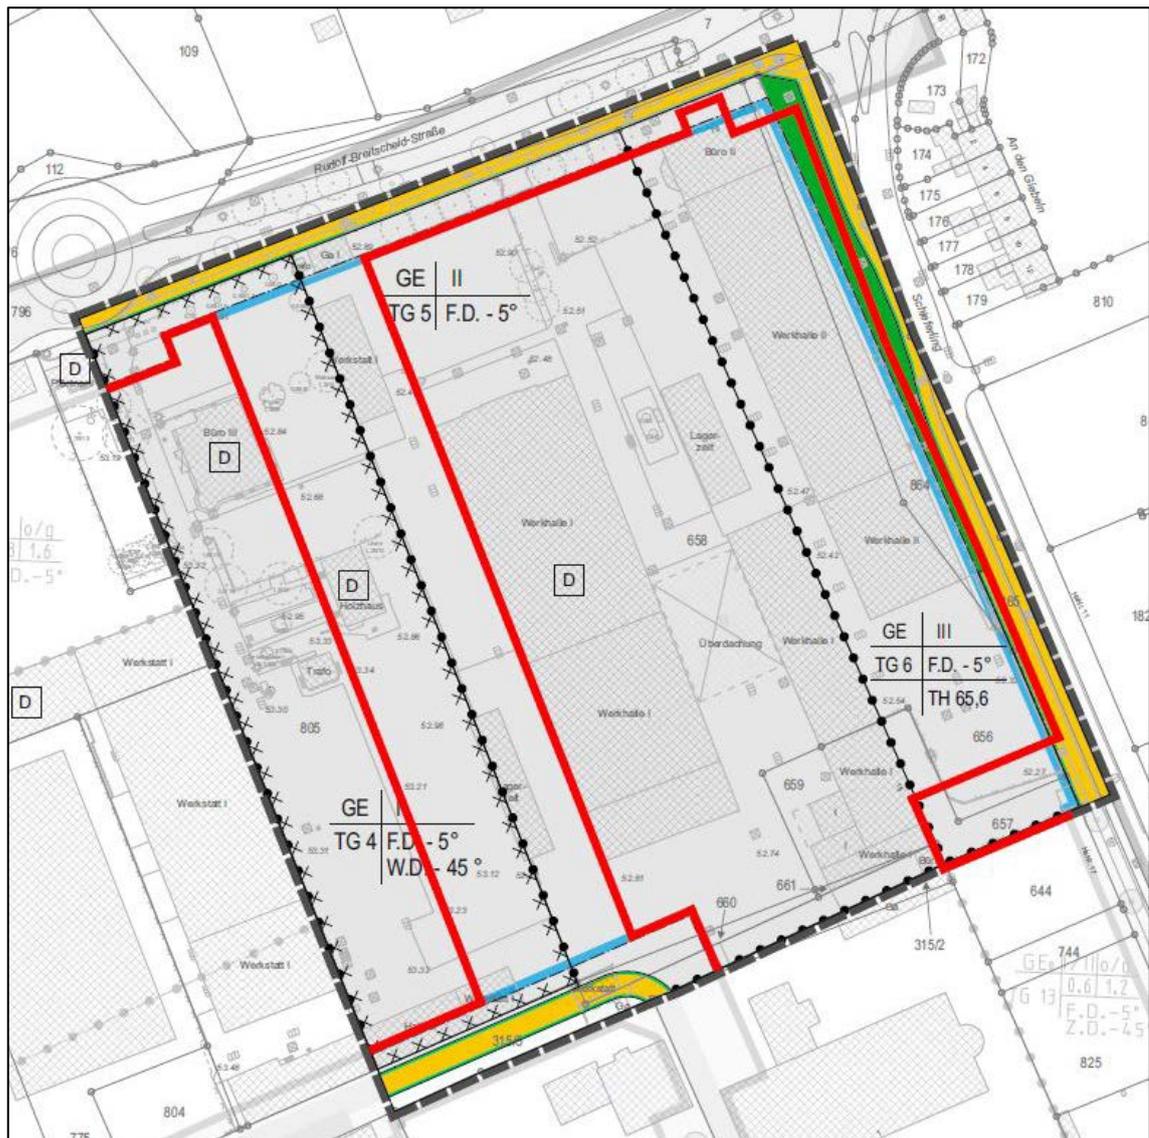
Nebenzzeichnung - Vergleich Baugrenzen Bebauungsplan Nr. 02/91 (rot) und Bebauungsplan Nr. 47/2020 (blau)
